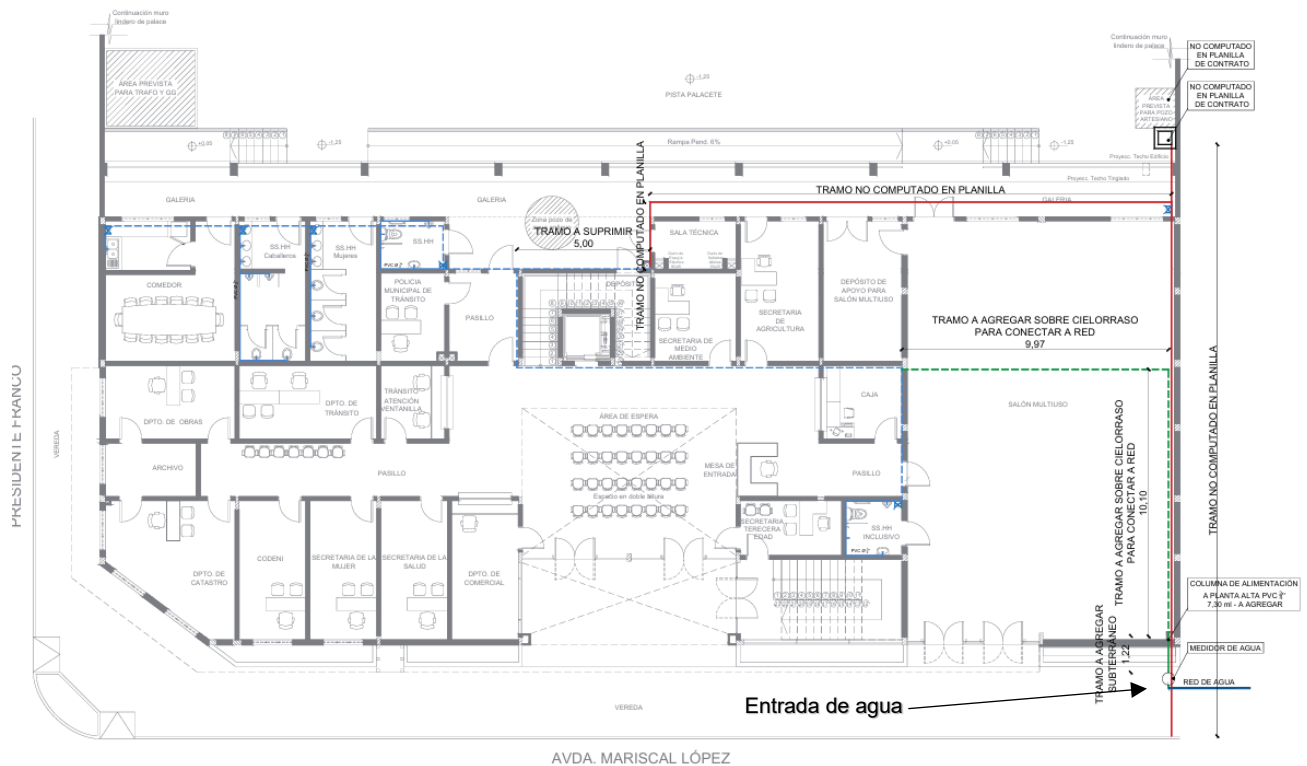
Replanteo del esquema de instalación de agua en planta baja.
